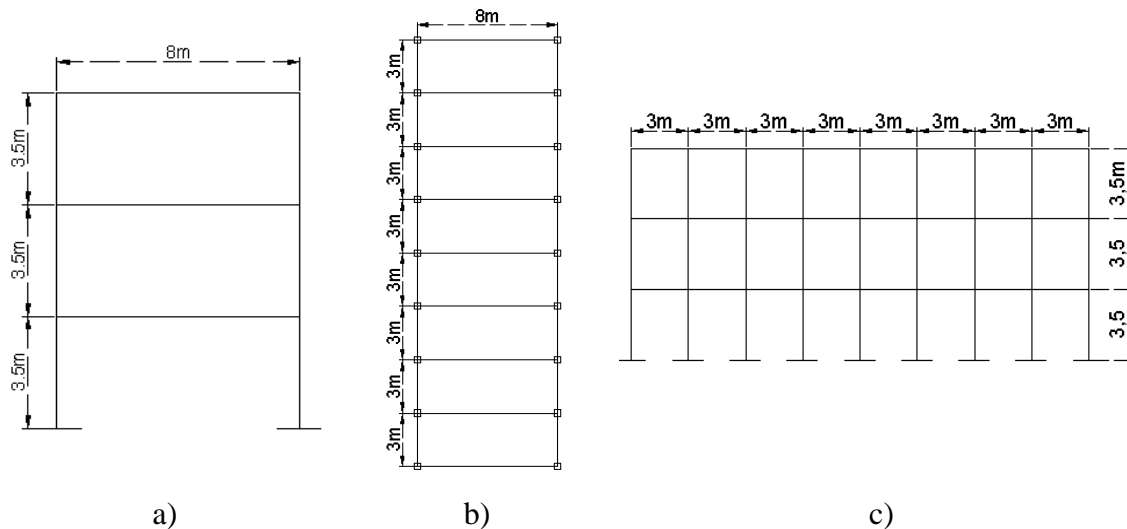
Geometría de las estructuras estudiadas a) Elevación lateral, b) Planta, c) Elevación frontal
